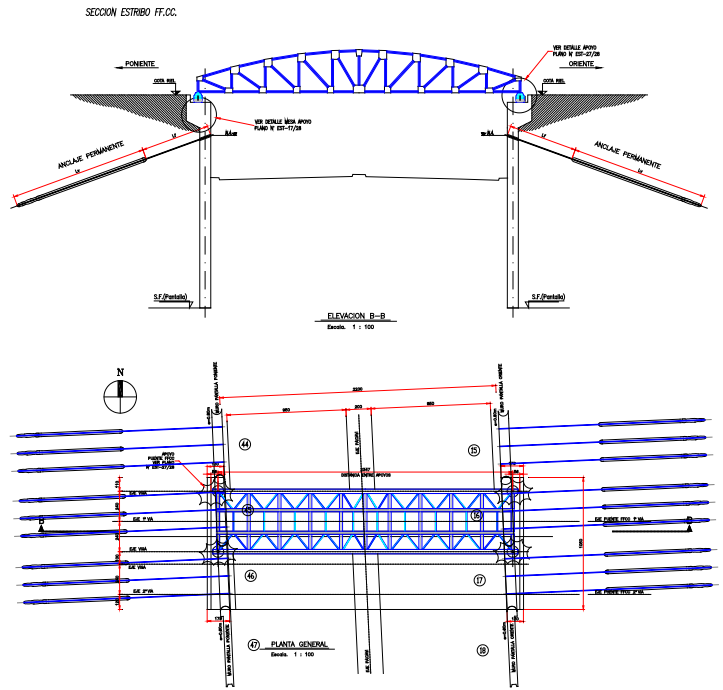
y 3 – Elevación y Planta del sector del puente FF.CC.
